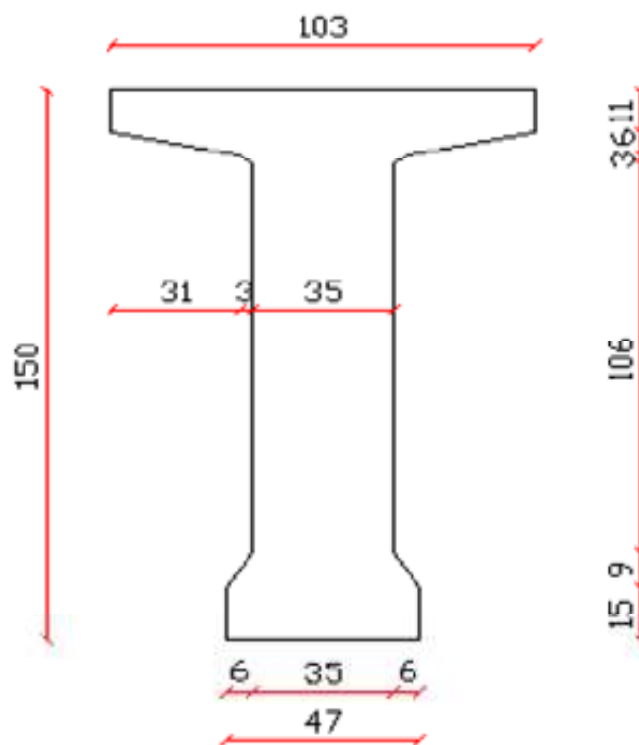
section de la poutre pour le calcul des paramètres fondamentaux
